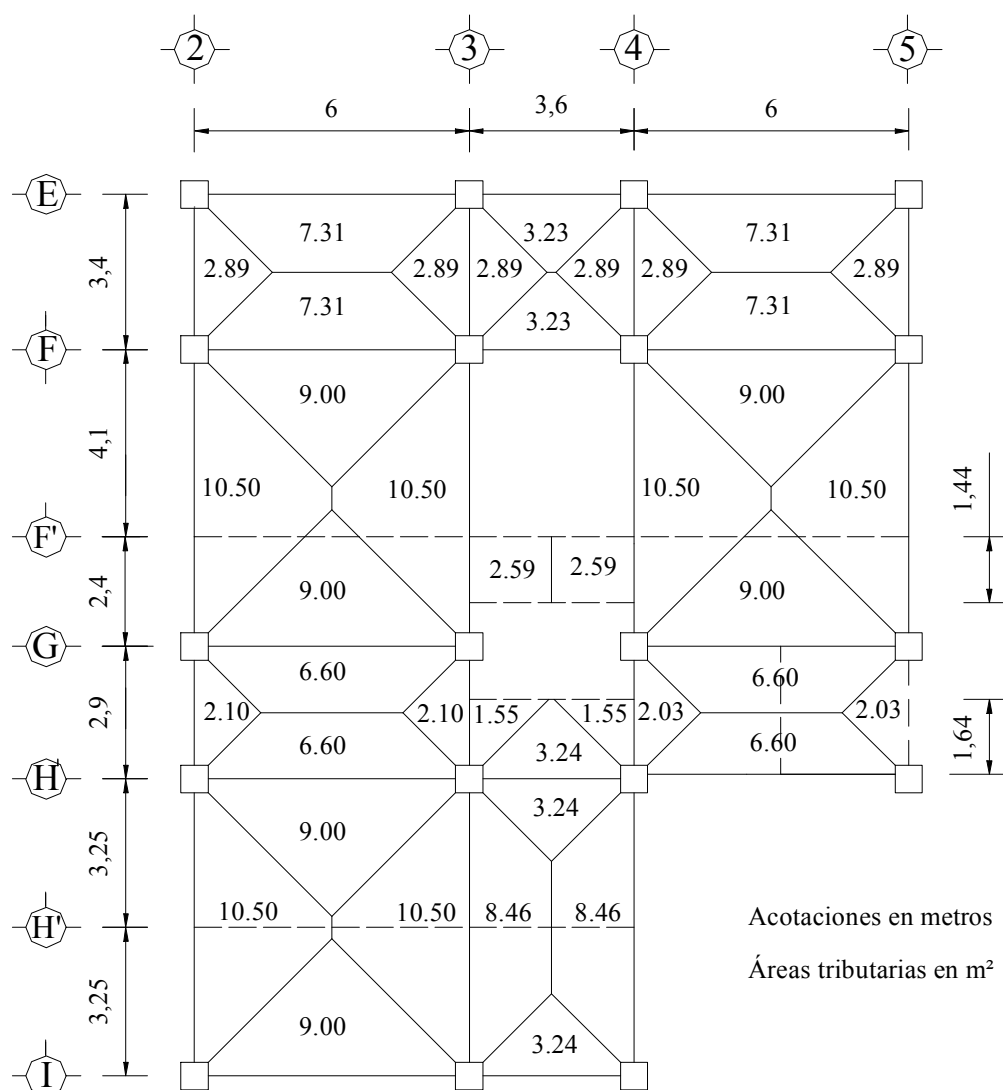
PLANTA TIPO CON LAS ÁREAS TRIBUTARIAS EN CADA MARCO
